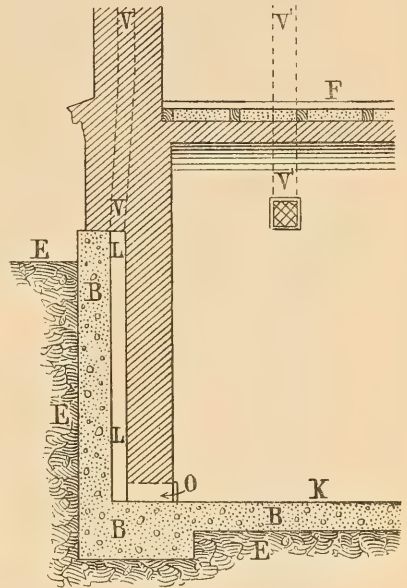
Isolierung eines Schulhauses gegen den Erdboden durch die Betonschicht *B* nach Nußbaum.
